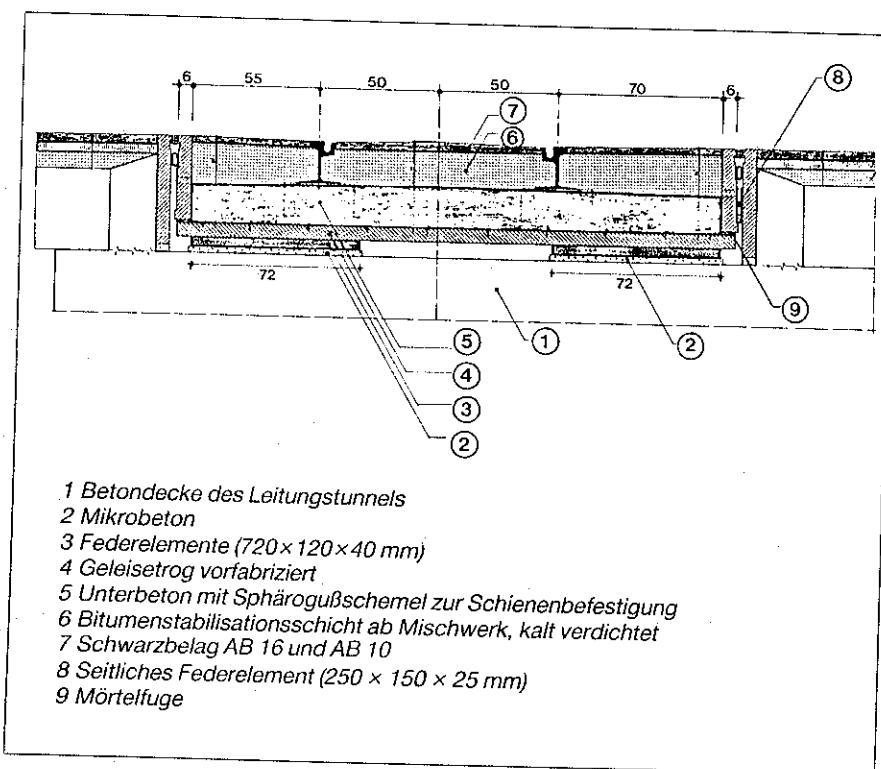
Schnitt durch den Geleisekörper mit Masse-/Federsystem
